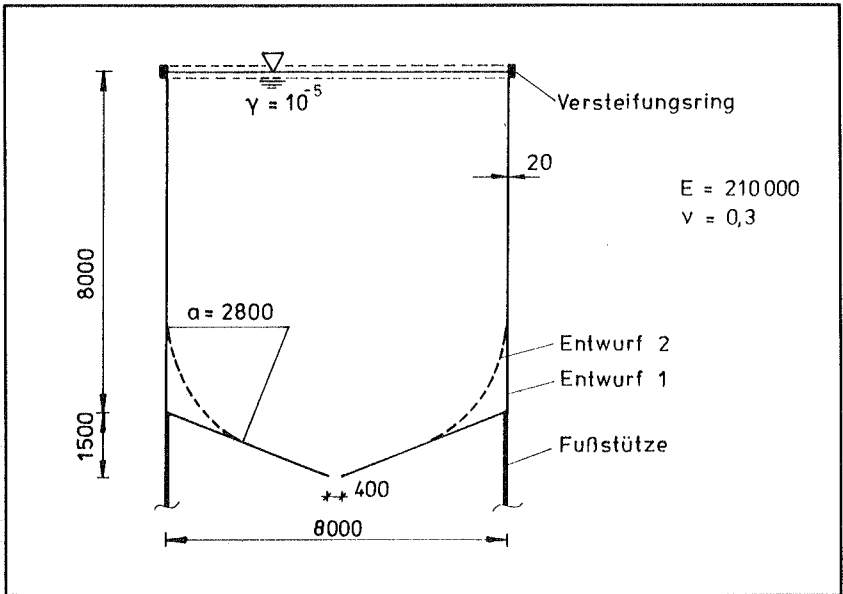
Wassergefüllter Stahlbehälter; der Entwurf 2 (ausgerundeter Zylinder-Kegel-Übergang) ist gestrichelt dargestellt.
